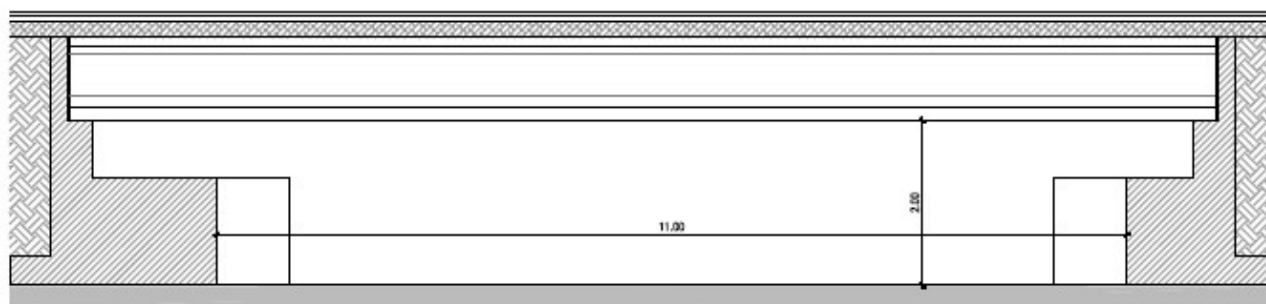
estratto tavola 2 progetto 'Demolizione e ricostruzione ponte sul canale tombato Corso Vittorio Veneto': la sezione E-E interseca il manufatto del viadotto non oggetto di intervento
